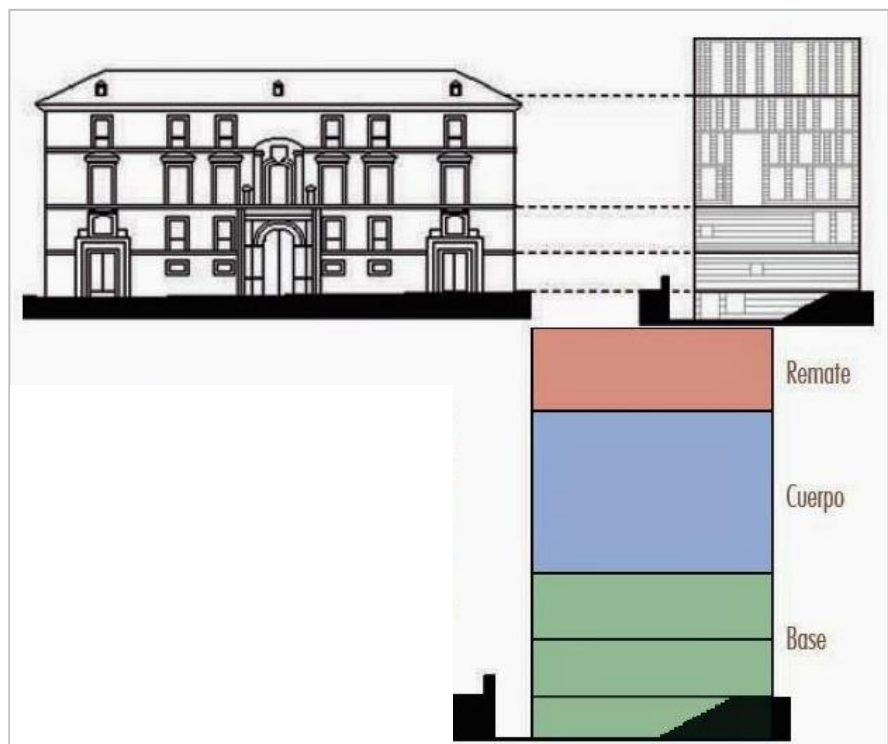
Elevación y Corte del ayuntamiento de Murcia.
